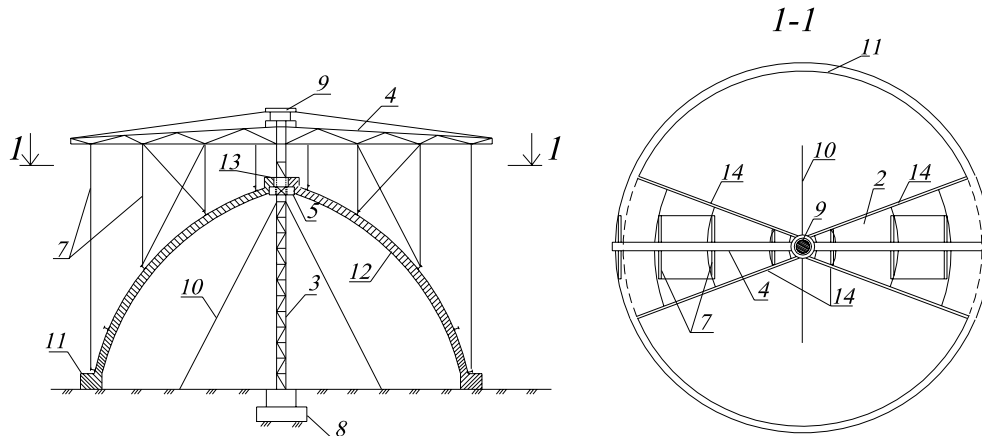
Забетонированные первые два сектора купола: 2 – опалубка купола; 3 – временная опора; 4 – консольная стрела; 5 – неподвижное кольцо; 7 – связи; 8 – фундамент временной опоры; 9 – гидродомкрат; 10 – растяжки; 11 – нижнее опорное кольцо; 12 – оболочка купола; 13 – верхнее опорное кольцо; 14 – ограничительные бортики.
